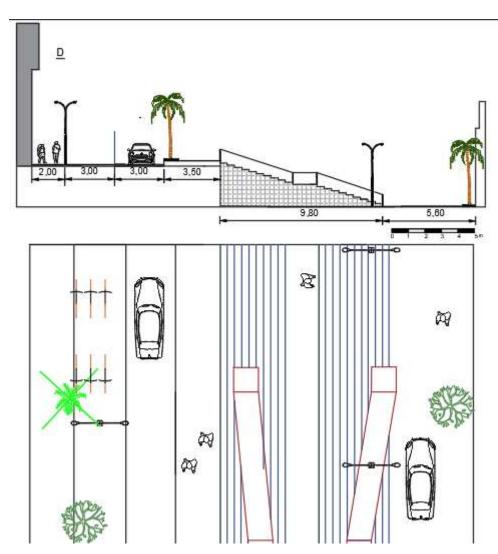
Sección D con graderío. (Se ha recortado la parte inferior de la planta ya que se muestra con mejor detalle en el Documento 2. Planos. en los planos de secciones propuestas
